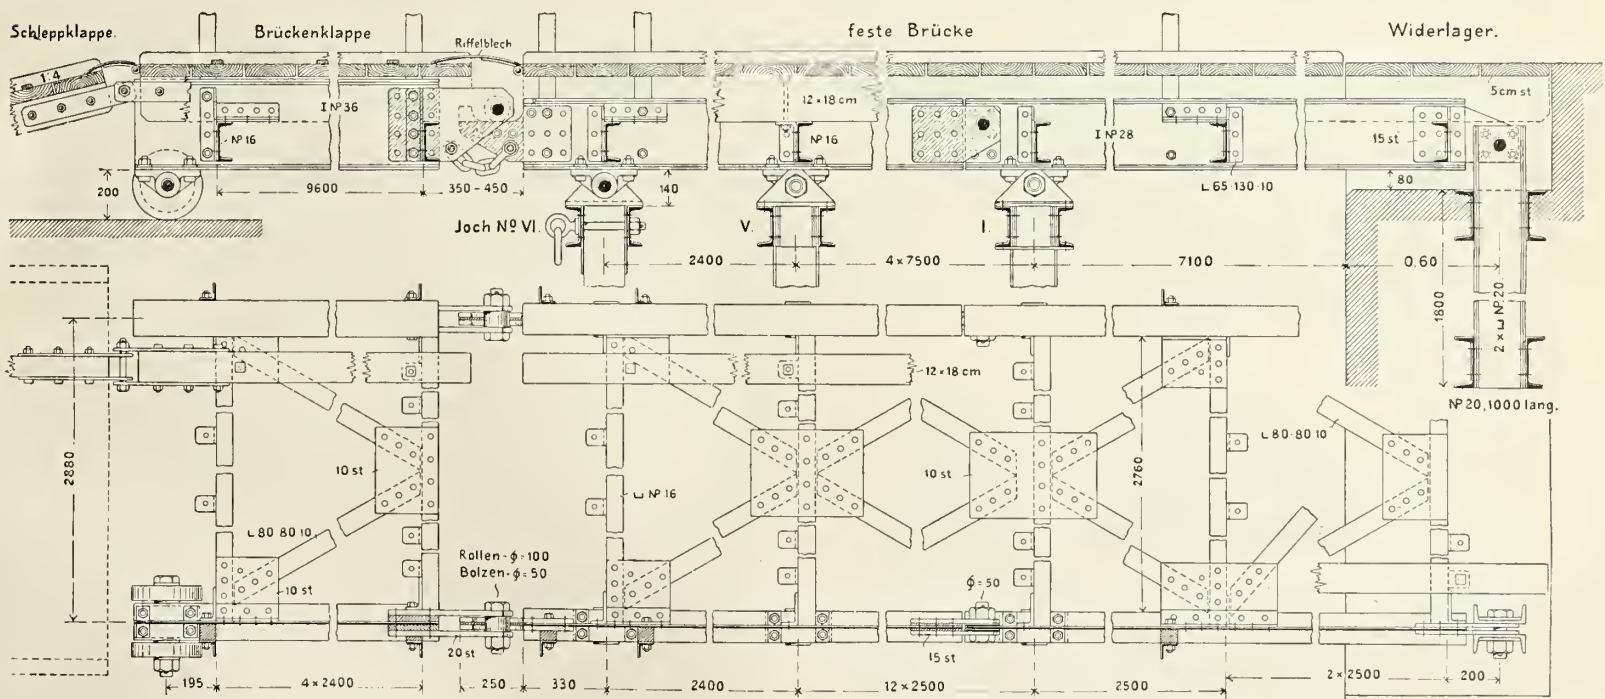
Längsschnitt und Grundriß der Brückenbahn.
